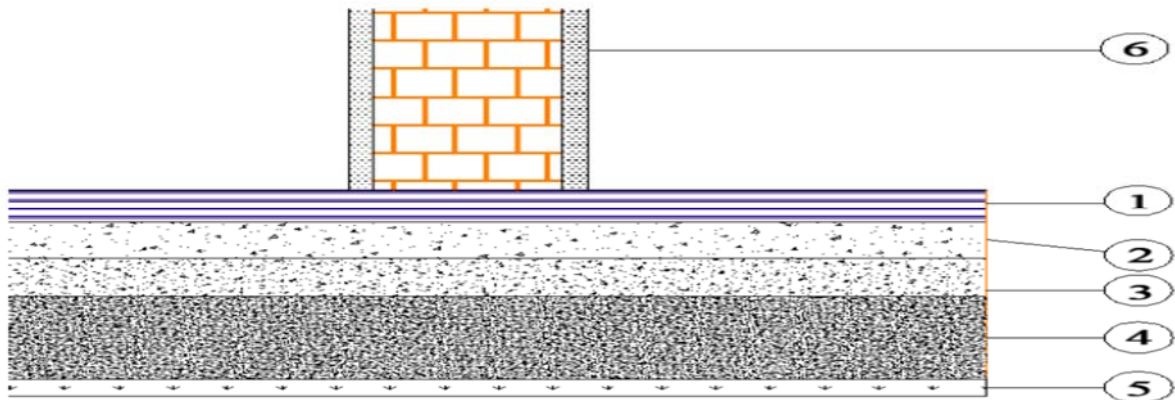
Coupe verticale du plancher en dalle pleine.
